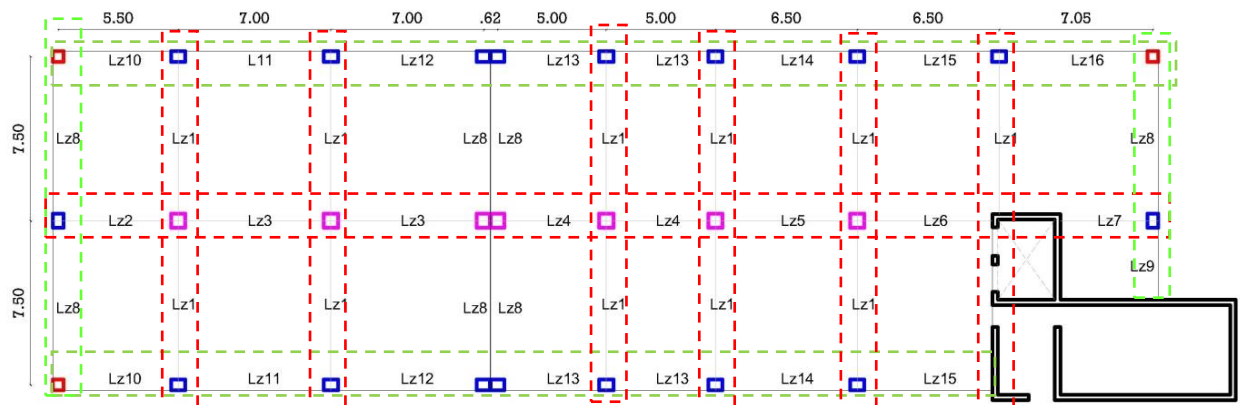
Distribución de vigas en Bloque A de la propuesta
